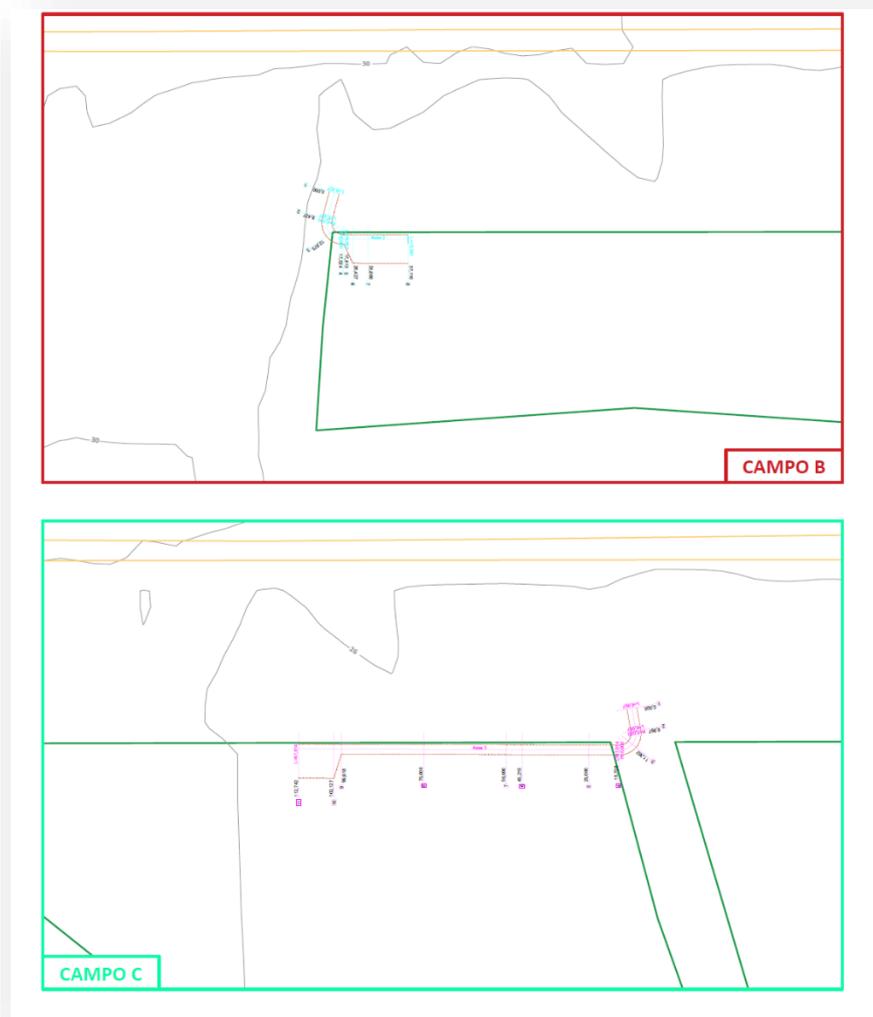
Estratto della tavola 22 – Planimetria Viabilità interna al parco
